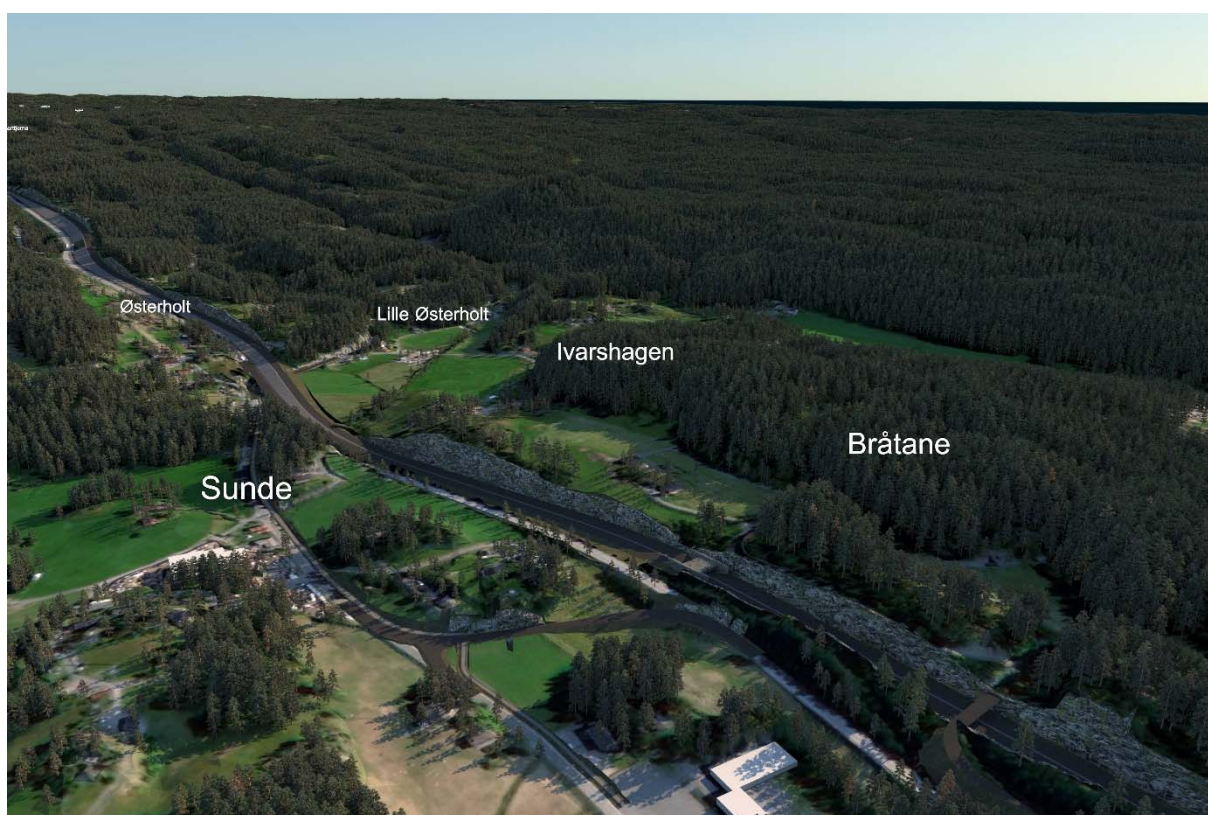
Kulturlandskapet på Østerholt. Eksisterende E18 midt i bildet. Sunde bru til høyre. (AsplanViak/Rambøll, 2018)
